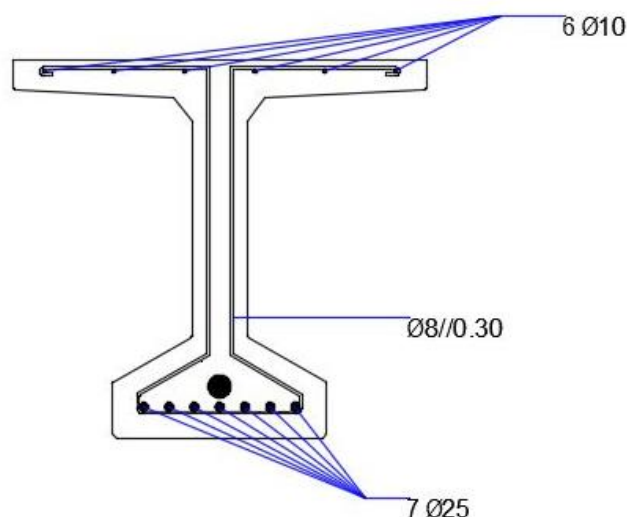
Representação esquemática das armaduras na secção a meio vão
